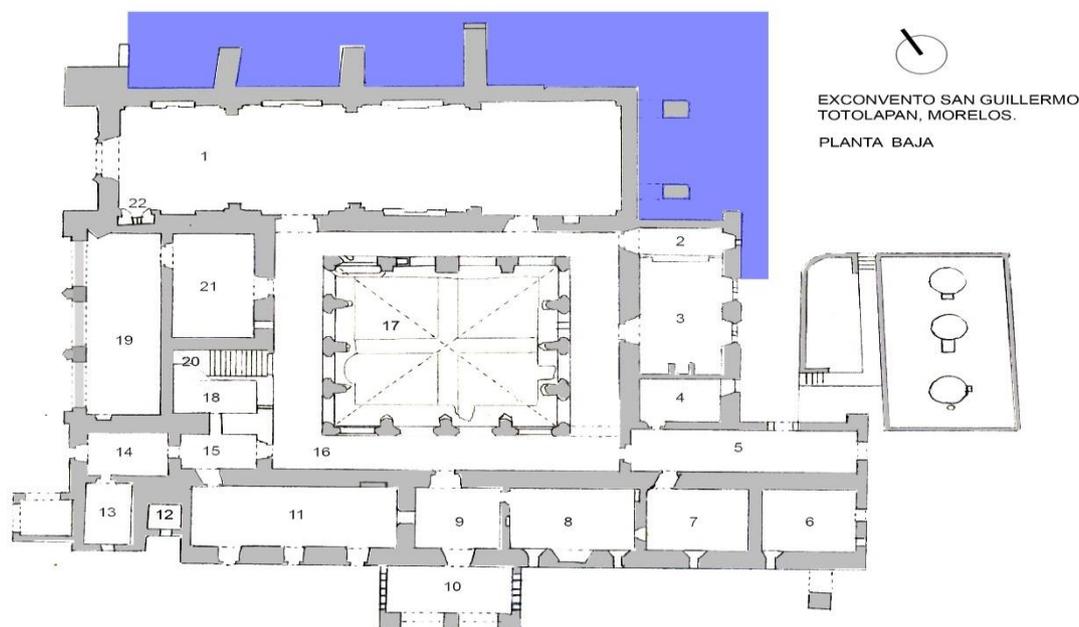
Zona de excavaciones en muros norte y oriente del templo, San Guillermo, Totolapan, Mor.
